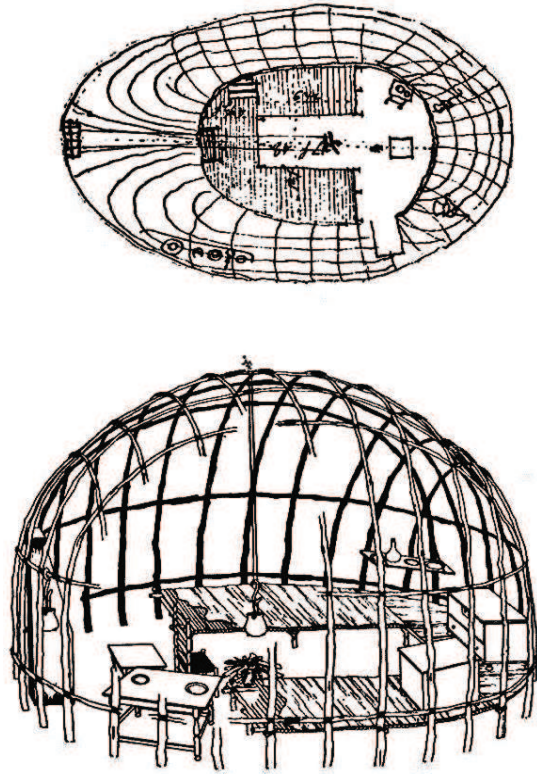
Schematischer Grundriss und 3D Schnitt eines Chippewa Wigwam mit Raumteilung
